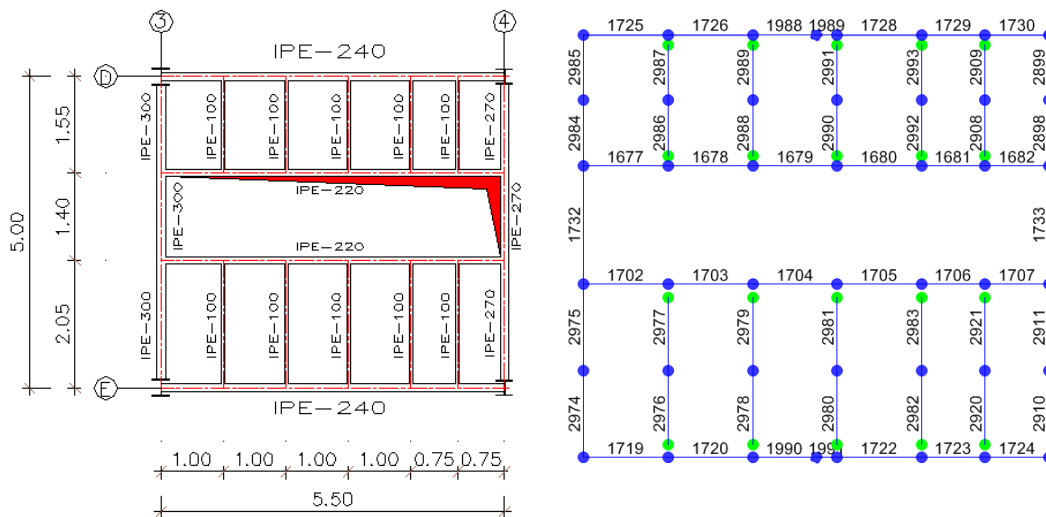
Planta com a Geometria e Identificação das Vigas Internas do Piso 1 dos Alinhamentos 3 e 4.
